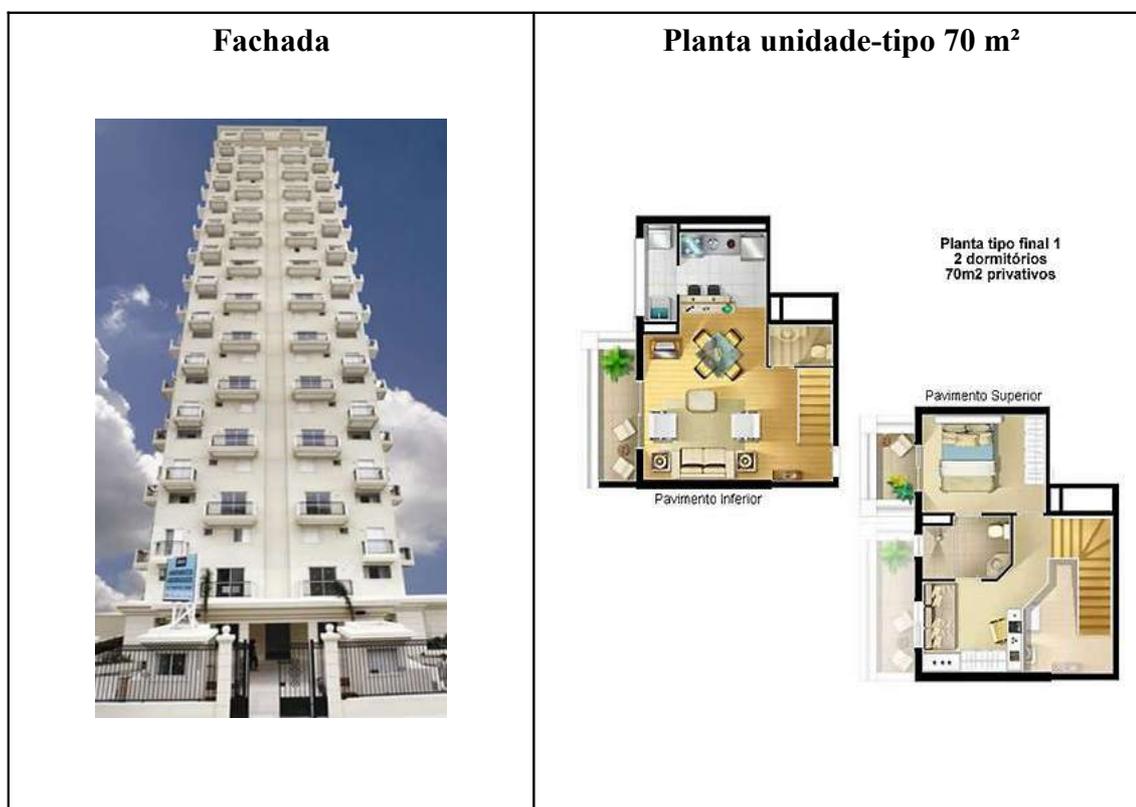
Projeto (fachada e planta-tipo) do Loft Pozelli – Pozelli Construtora e Incorporadora (2005)
